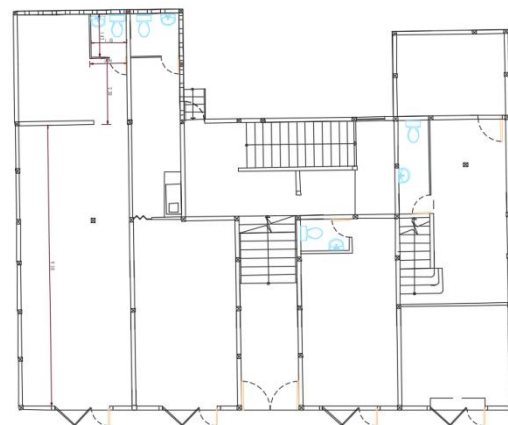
Plano arquitectónico de la planta baja de la Casa Flor Cedeño. (INPC, 2017)
